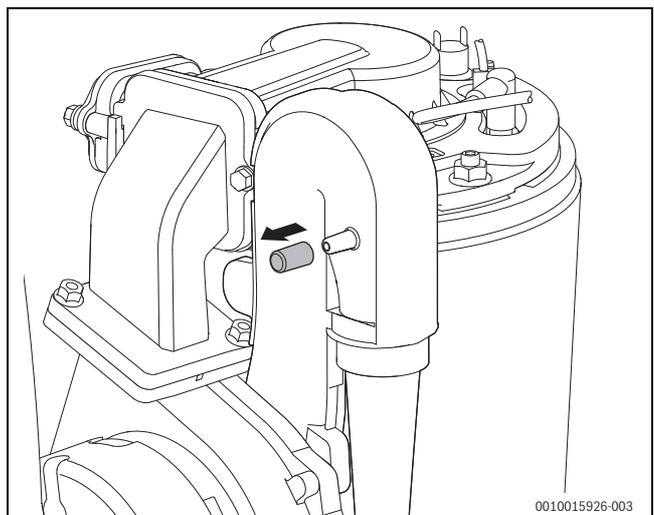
Tubulure de mesure sur le dispositif de mélange
